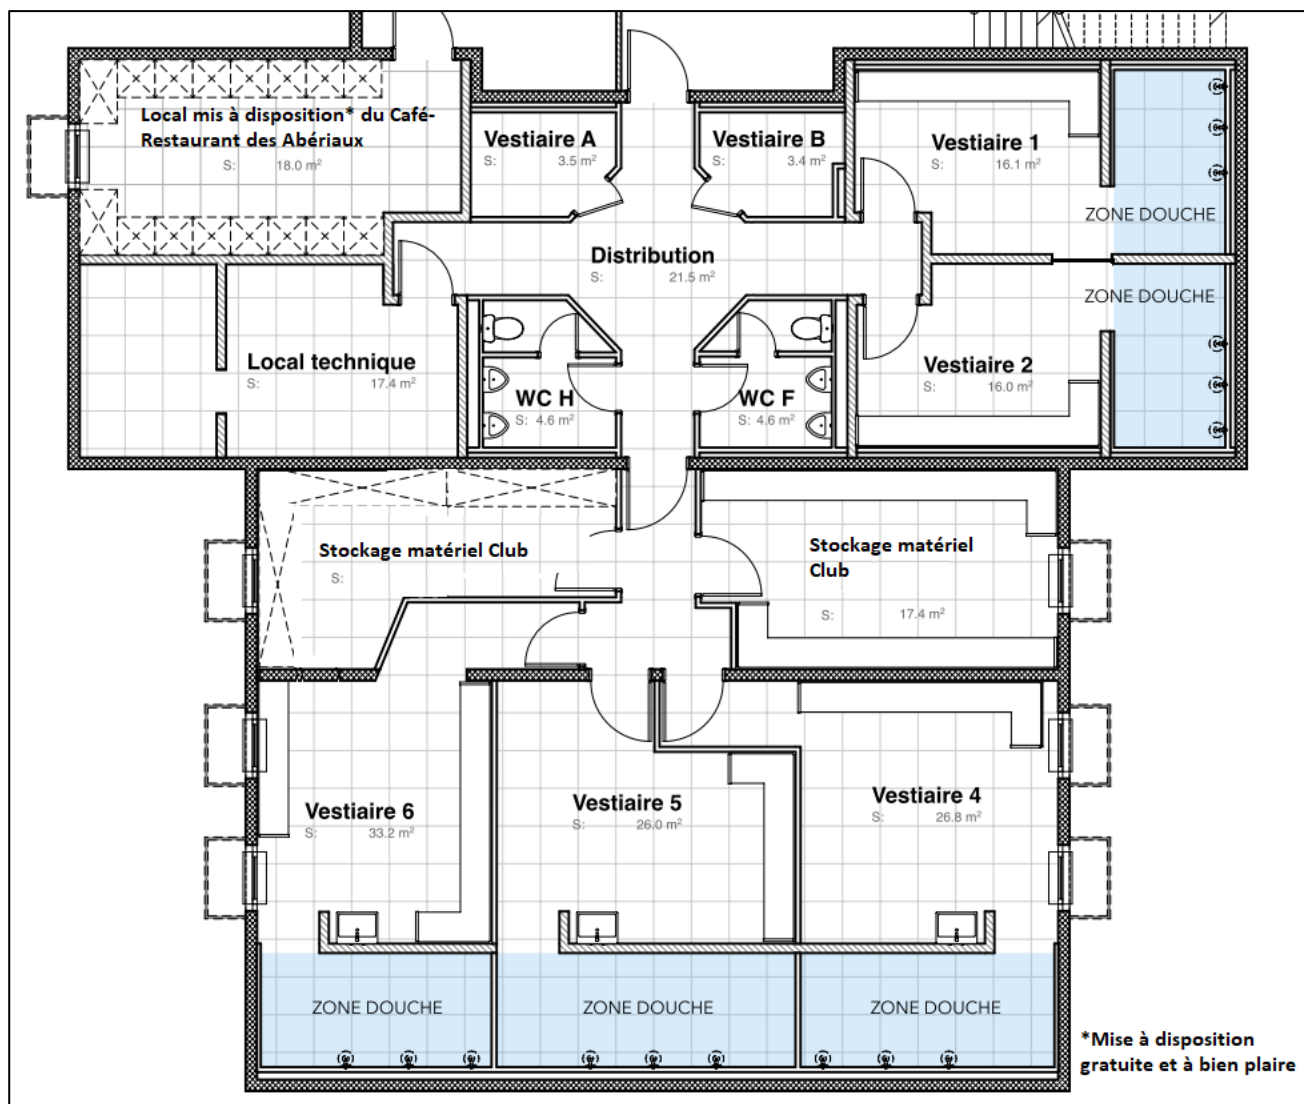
Plan actuel du sous-sol du bâtiment des Abériaux
